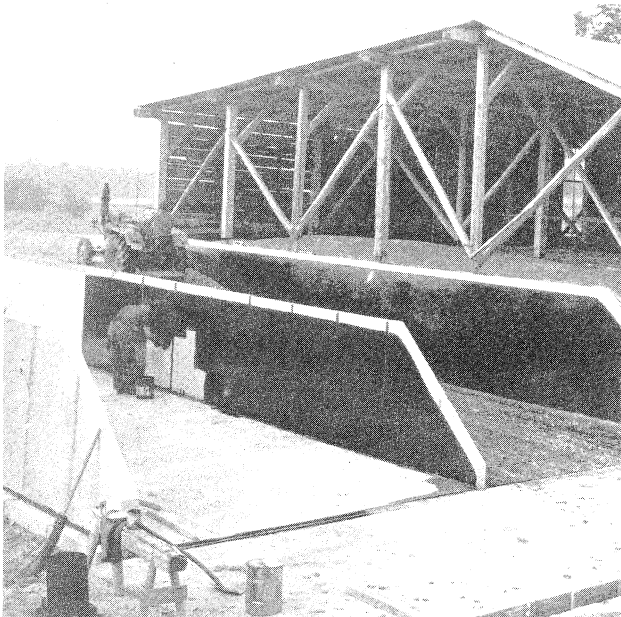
Flachsilo mit Bitumenanstrich (gefüllte Ausführung); oben mit Kunststoffanstrich wegen der PVC-Folie zum Abdecken.
